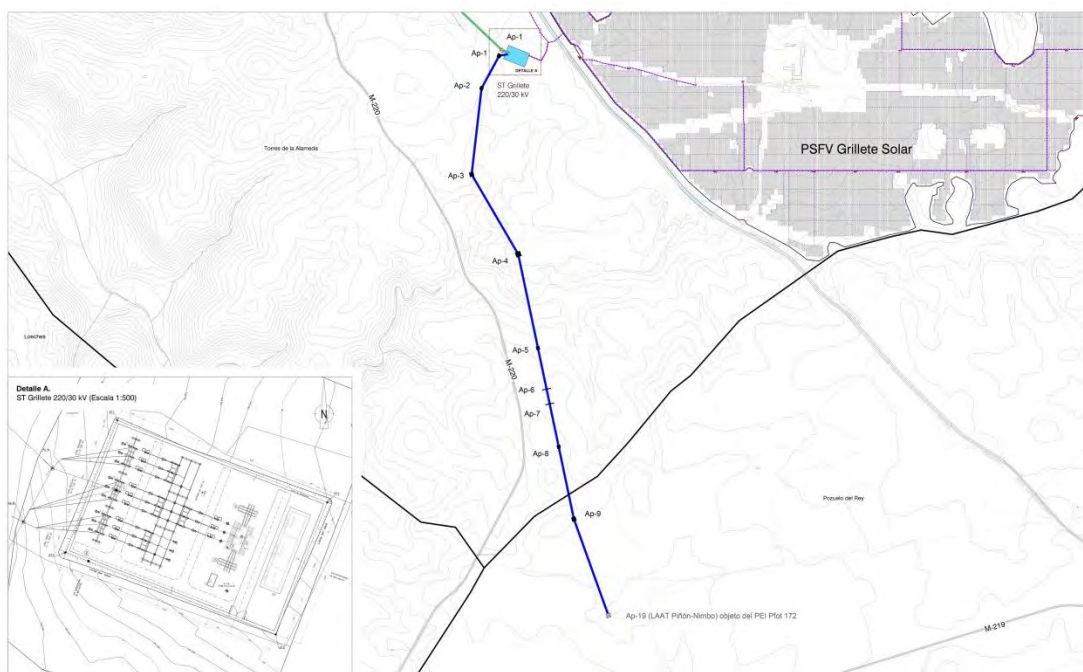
Detalle de implantación de la ST Grillete. Fuente: RH Estudio.
